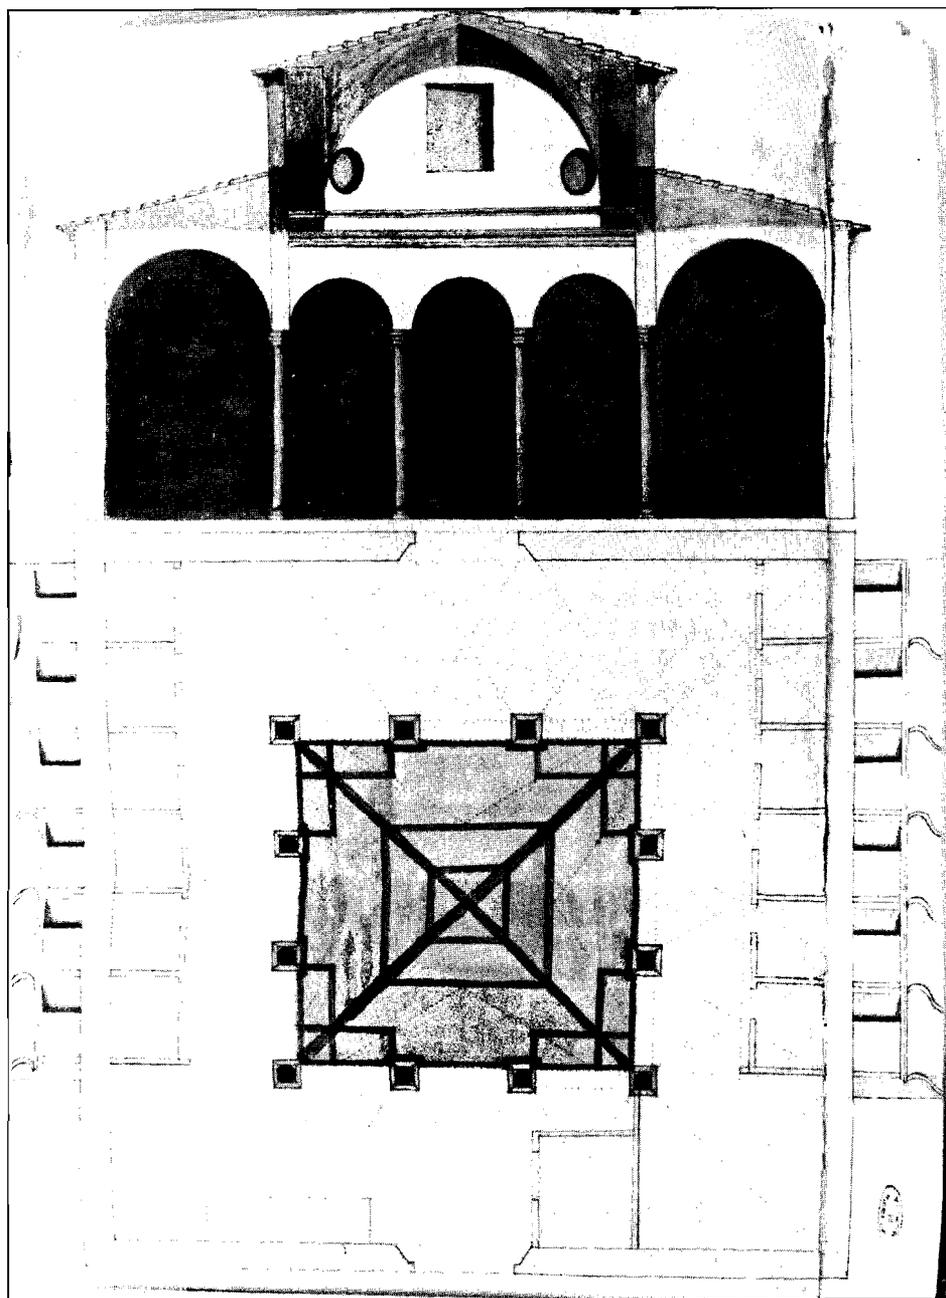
Carnicería Mayor de Murcia. Planta y corte transversal del alzado
